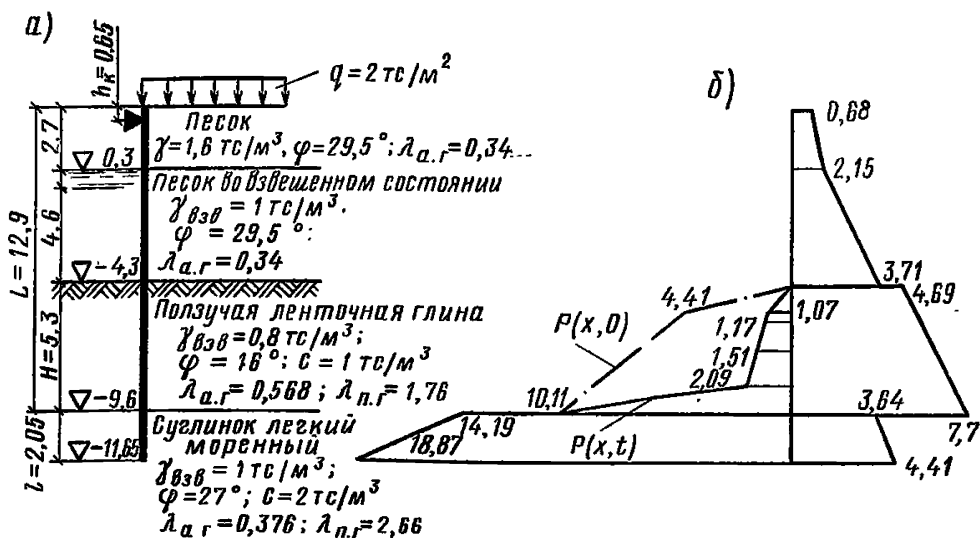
Эпюры активного давления грунта на одноанкерную шпунтовую стенку
